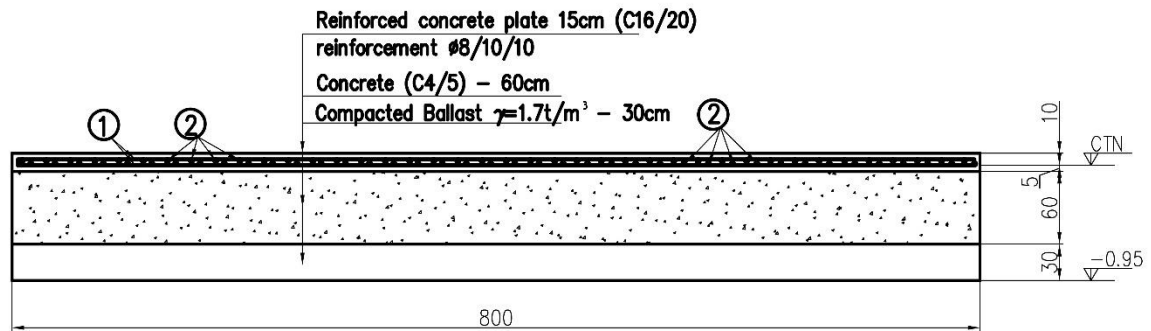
Secțiune prin platforma betonată pentru transformatorul de medie tensiune
